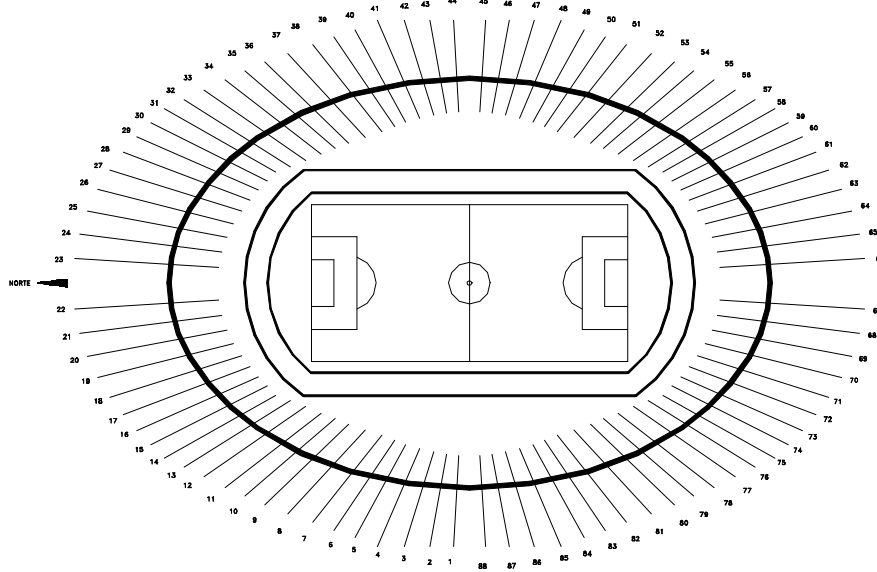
Croqui em planta do estádio de futebol em estudo, com a localização dos pilares.
